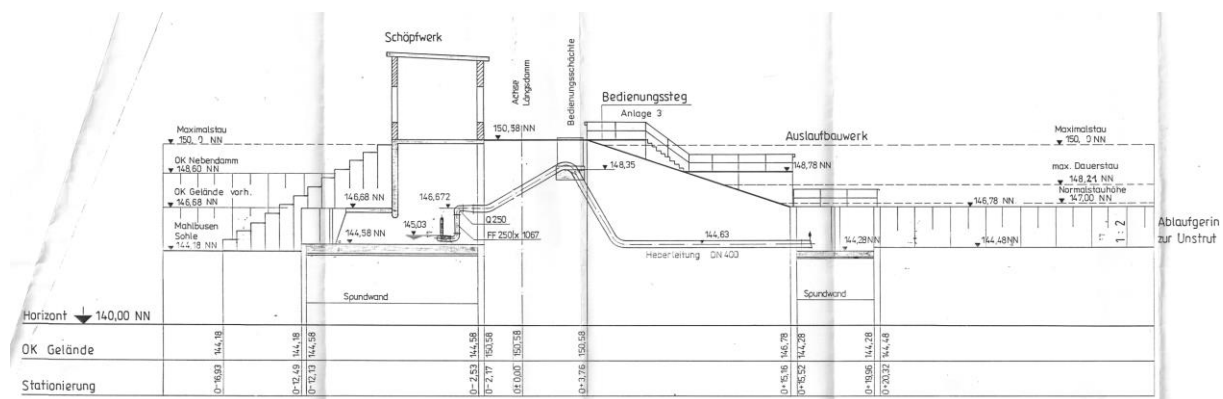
Auszug aus dem Plan 5.2/1 „Lageplan 2 – Heberleitung“
